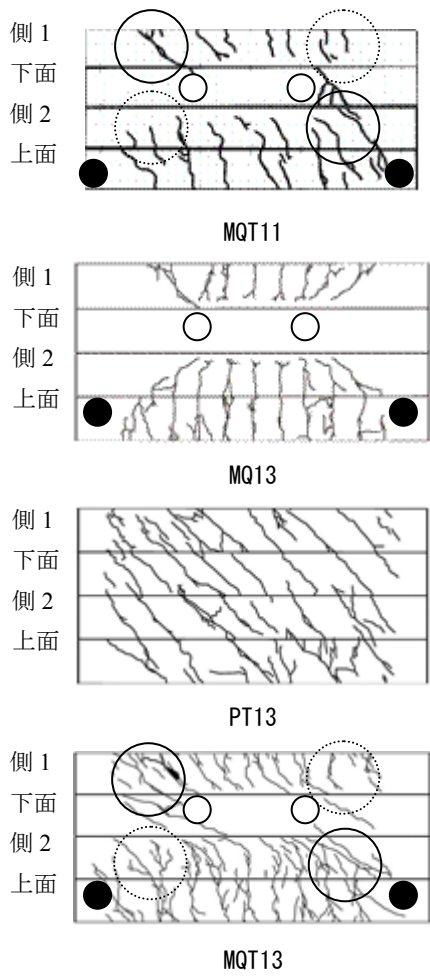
ひび割れ図(※支点:●, 載荷点:○)
